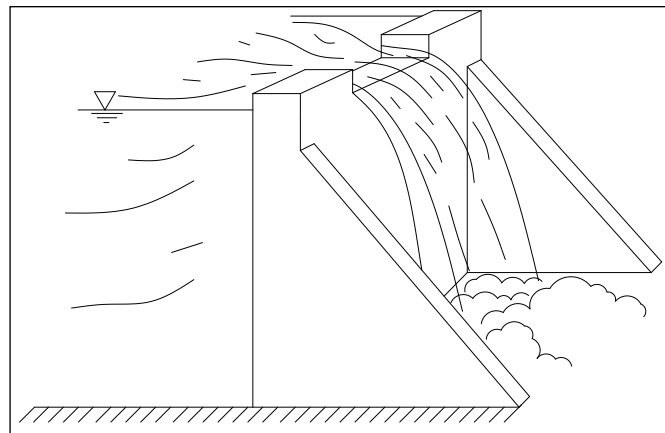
Vertedor de Caída libre (Presa de Contrafuertes)
